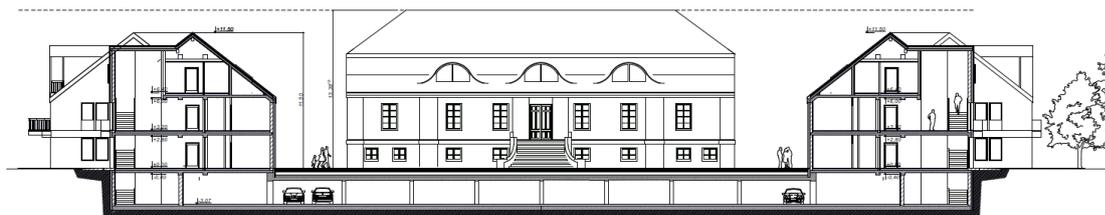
Schnitt durch die geplanten Kavalierhäuser mit Tiefgarage<sup>24</sup>
